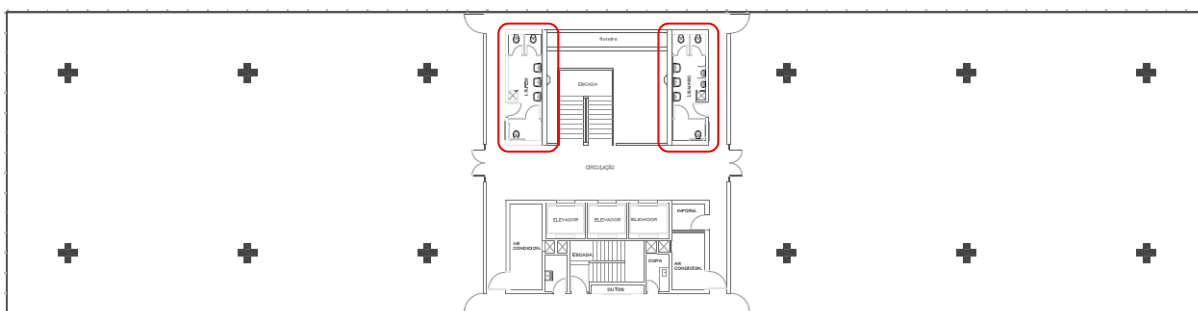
Sede MPPR. Pavimento Tipo. Destaque para os sanitários.
